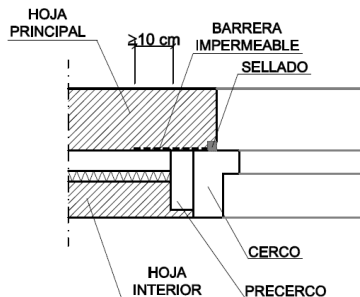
Ejemplo encuentro de la fachada con la carpintería.
